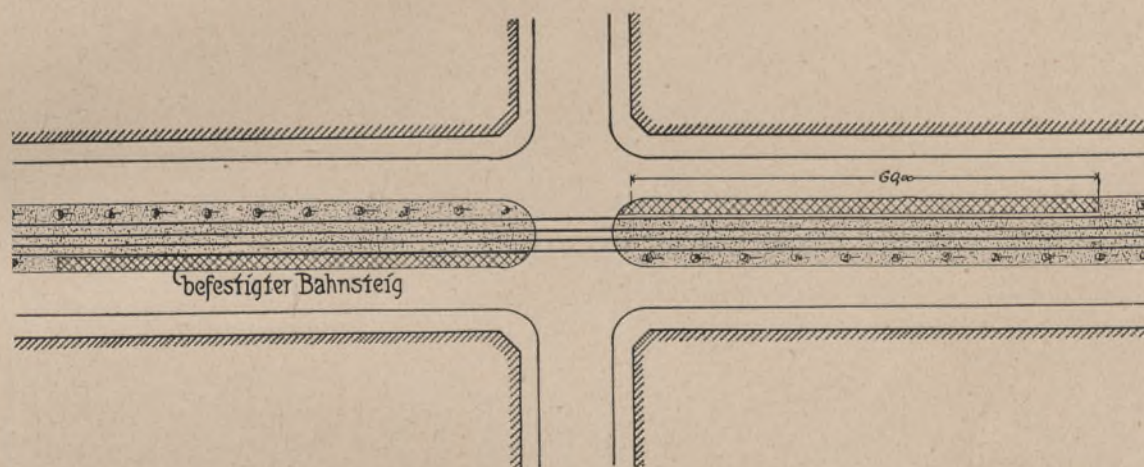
Grundriß einer Haltestelle der Schnellstraßenbahn.
